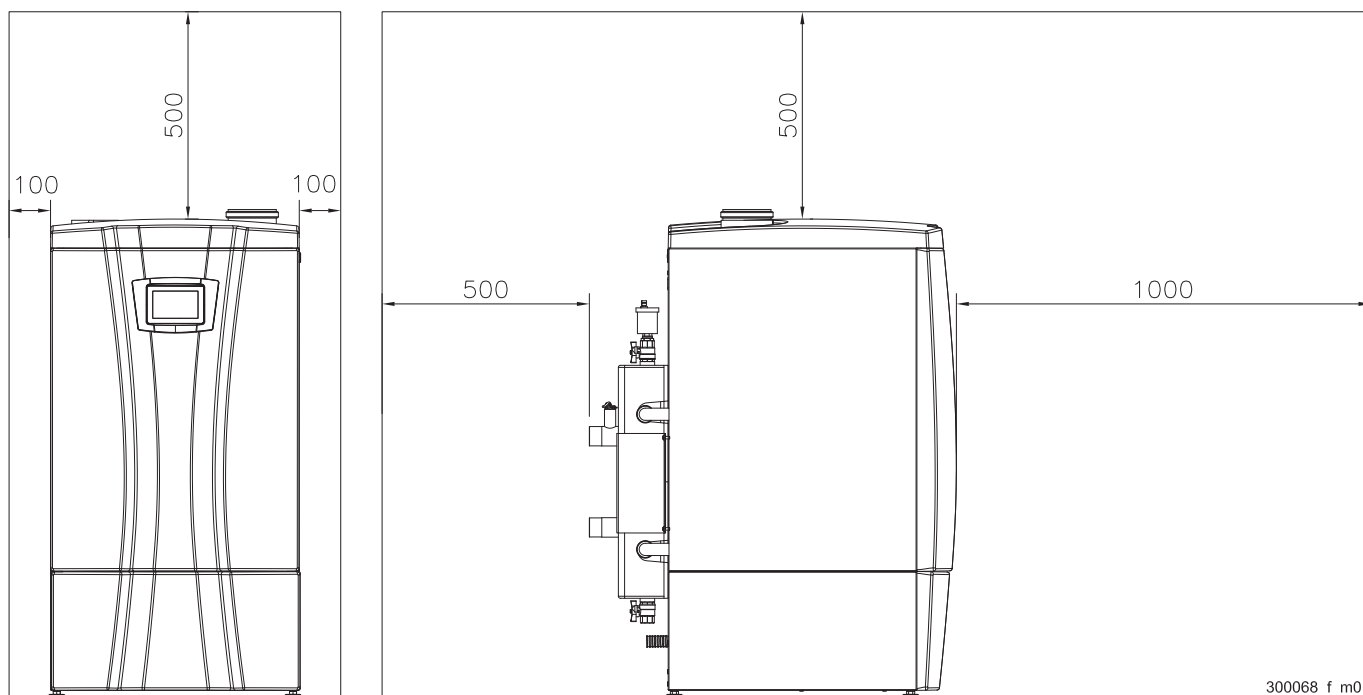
Distanze minime di rispetto modelli TE 60-70-100-115-140
